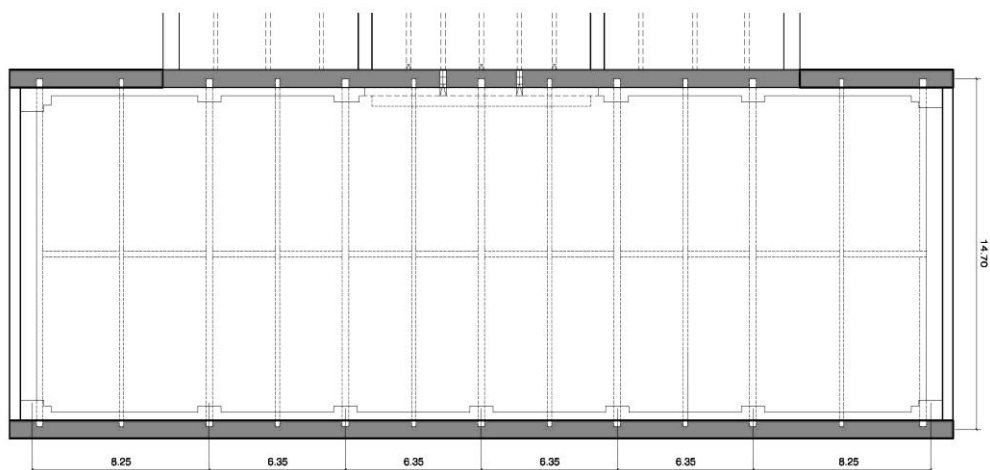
Planta de estructura de sala de máquinas. Pórticos de cerchas de madera y metálicas y muro de carga de mampostería de piedra. E: 1/200. Fuente: el autor
